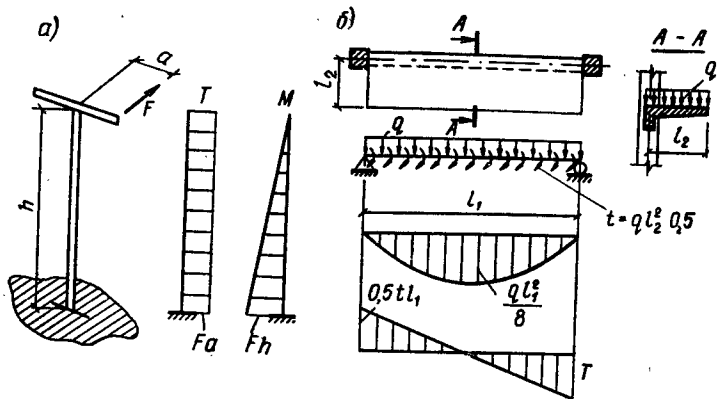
Железобетонные элементы, работающие на изгиб с кручением
